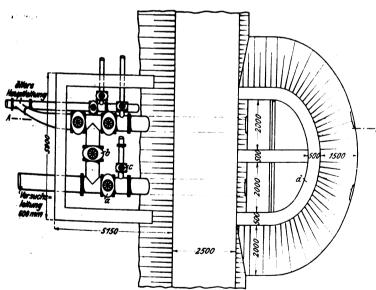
und 2 geben einen Lageplan der untersuchten Rohrleitungsanlage. Das Oberwasser bildet ein vom Elektri-
